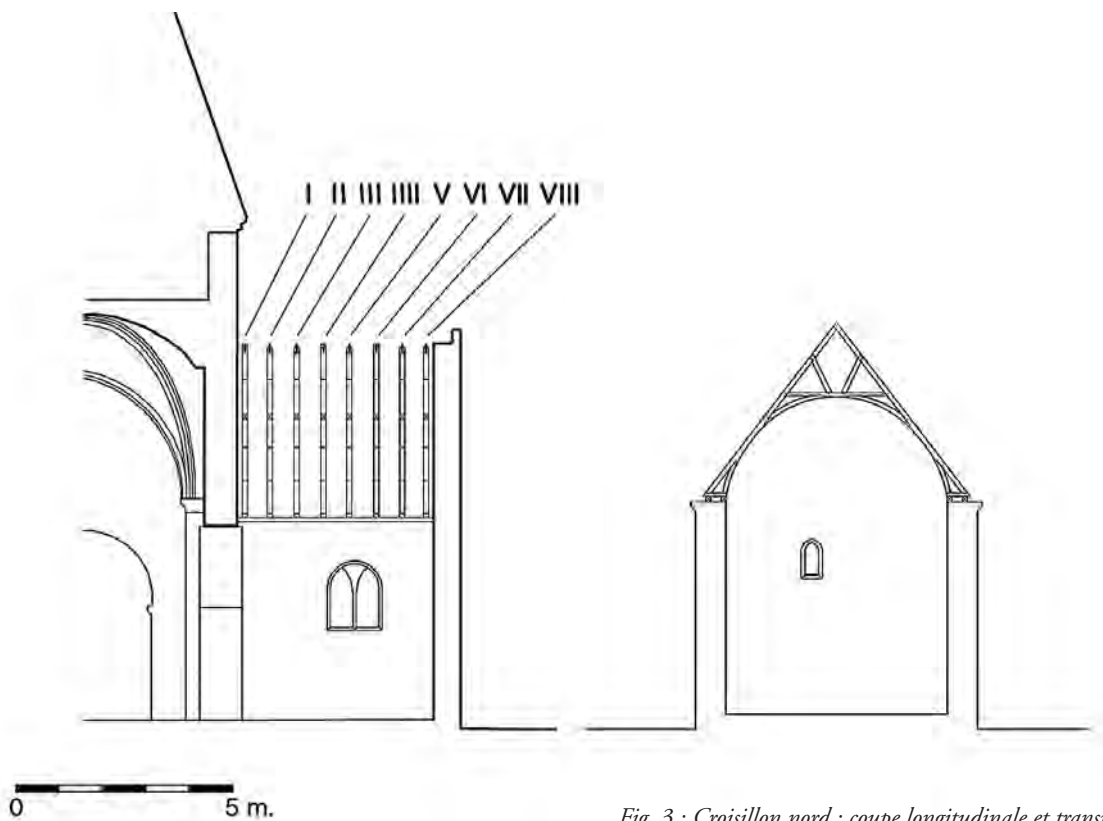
Croisillon nord : coupe longitudinale et transversale.
